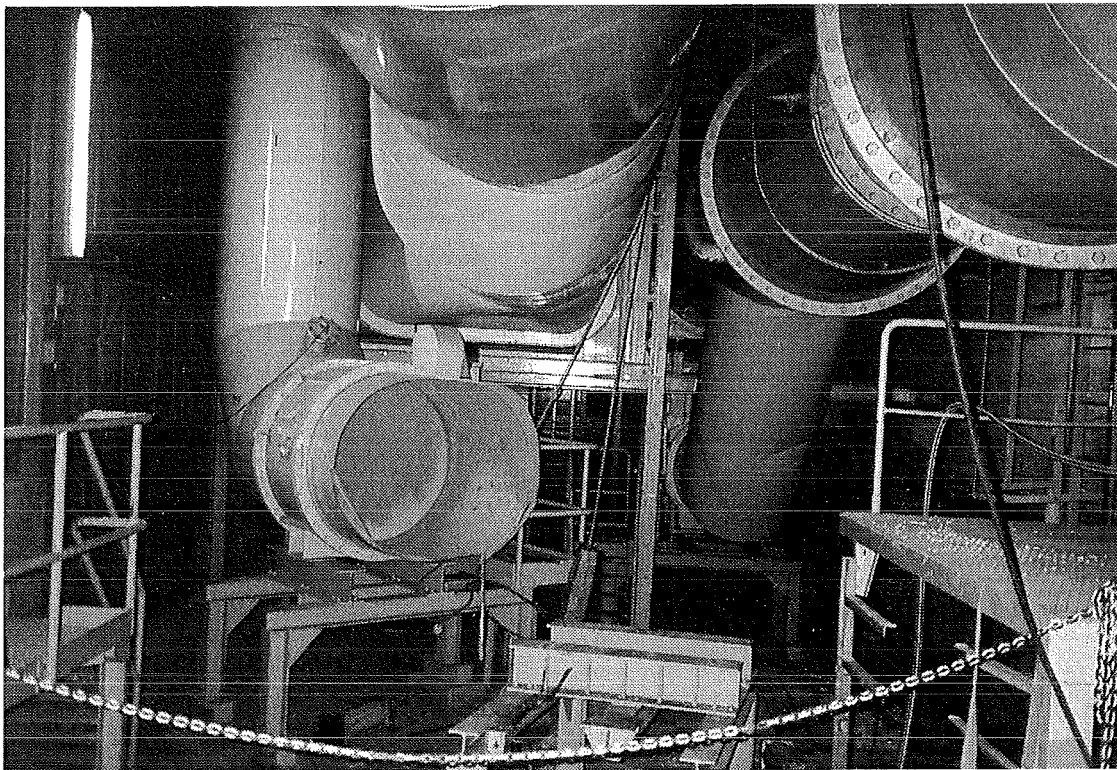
Demontagen der Lüftungstechnischen Einrichtungen (3)
